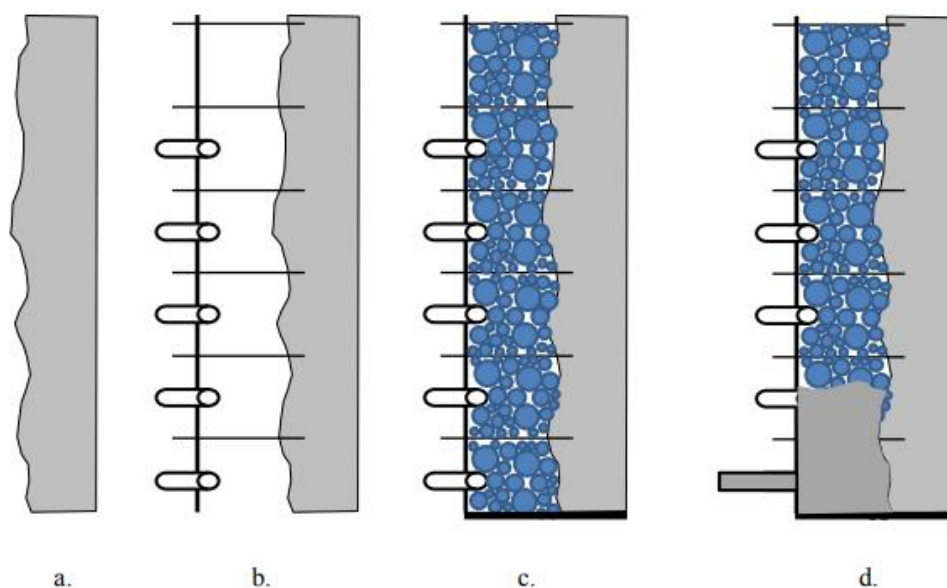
Fördelning av cement och ballast i fabriksbetong (Xu et al., 2025).
